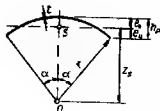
Внешний слой в форме цилиндрического свода-оболочки
